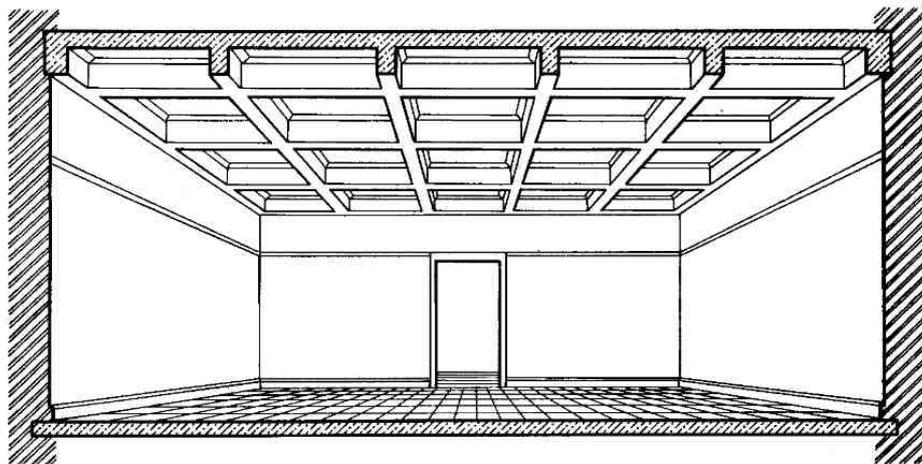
Общий вид железобетонного монолитного кессонного перекрытия
